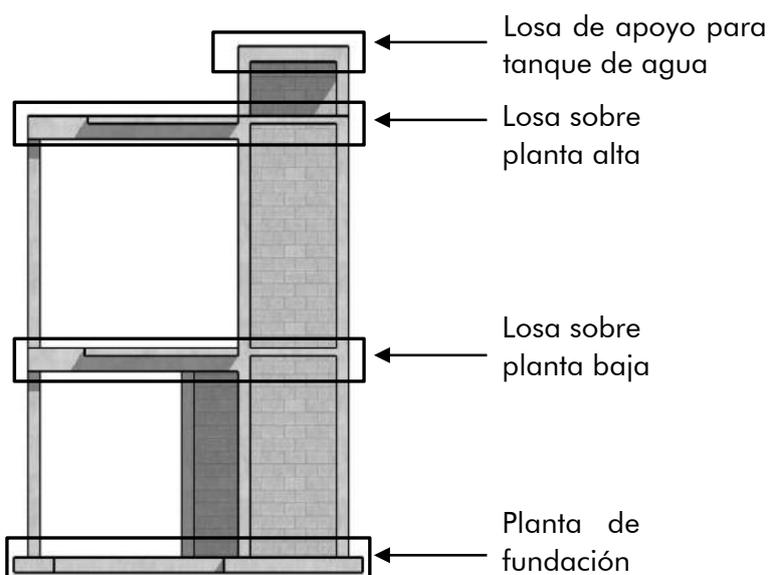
Planos de planta necesarios para describir la estructura de la vivienda Los Prados
